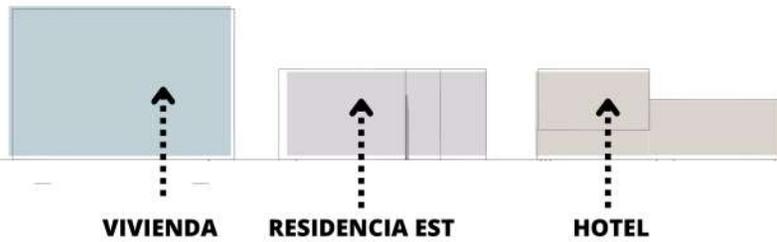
Planta Baja #6. Elaboración propia, 2022
